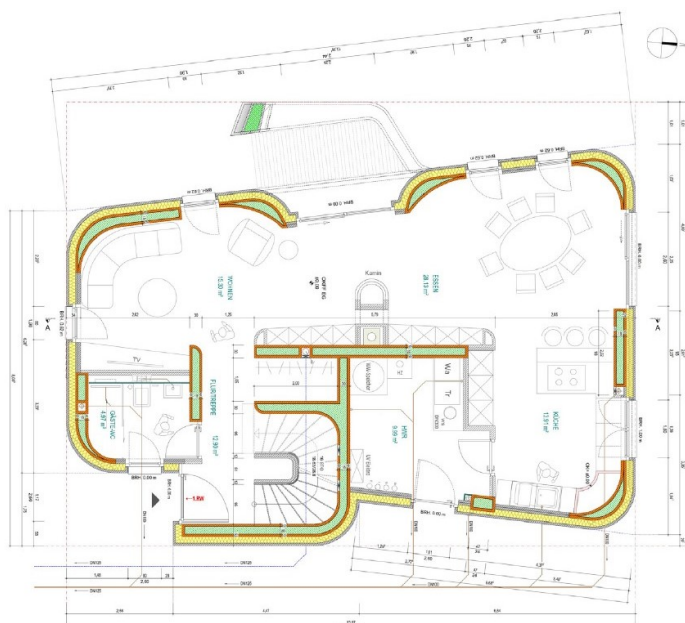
Planimetria della *Beckum House* (Weger et al. 2021).
